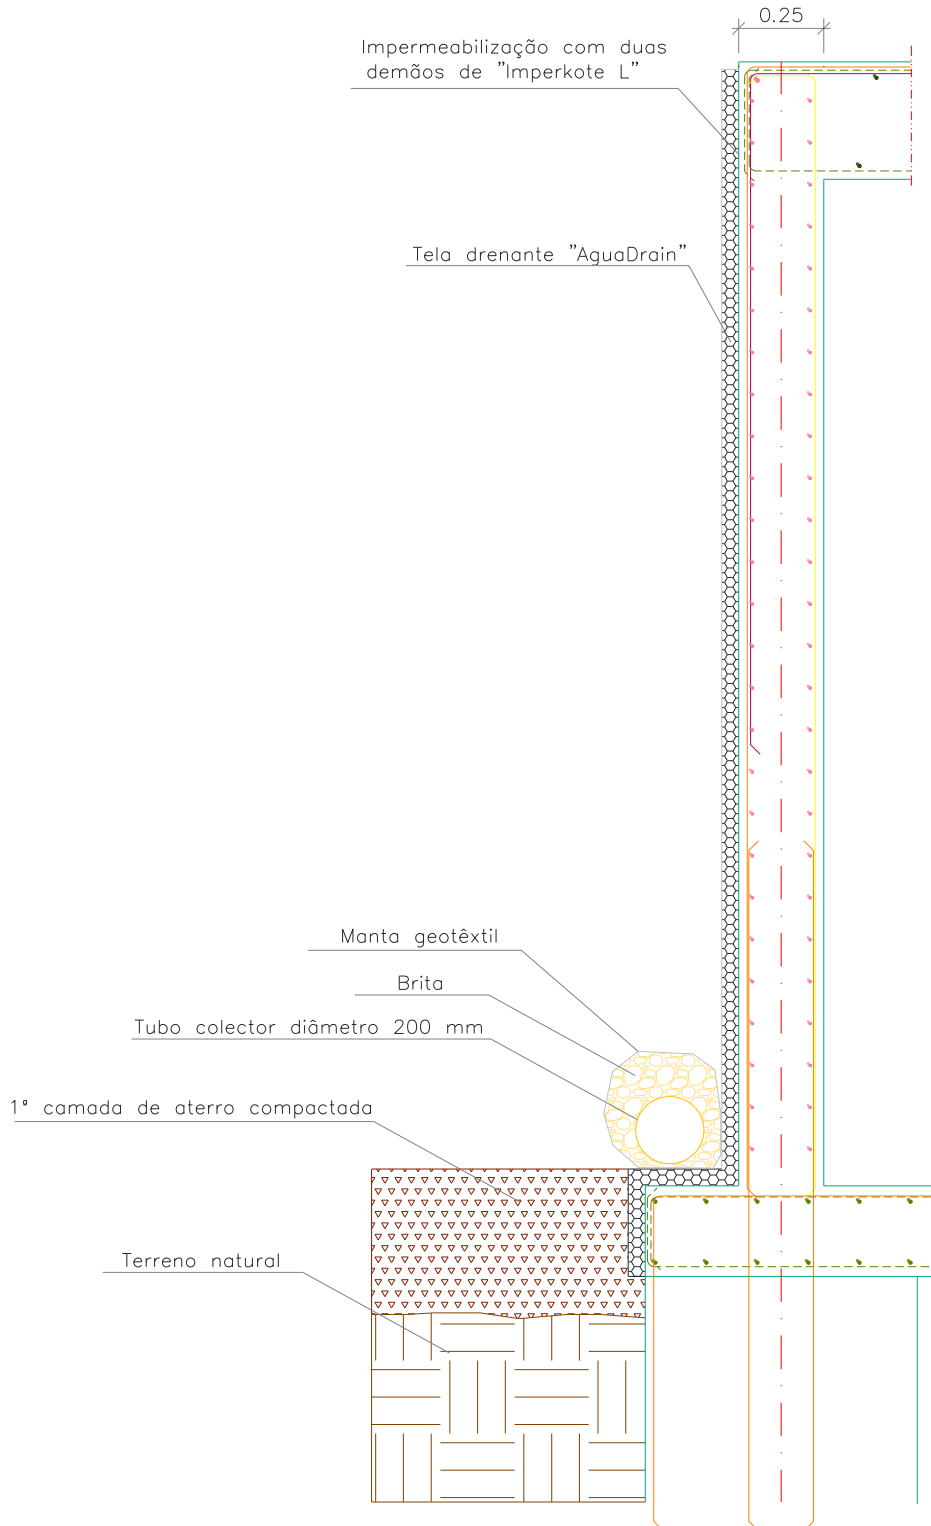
Corte construtivo de sistema de impermeabilização e drenagem aplicado.
